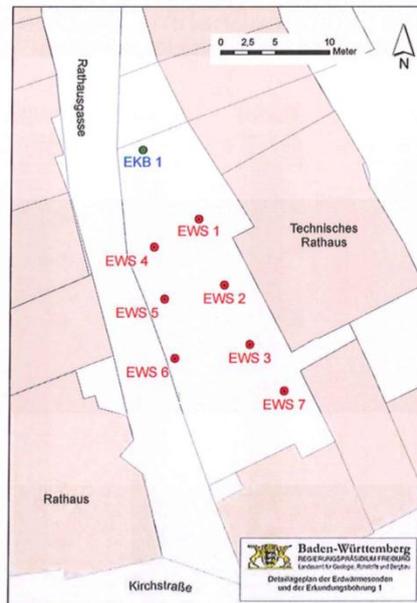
Lageplan mit Eintrag der Erdwärmesonden EWS 1 bis EWS 7 und der Erkundungsbo EKB 1.
